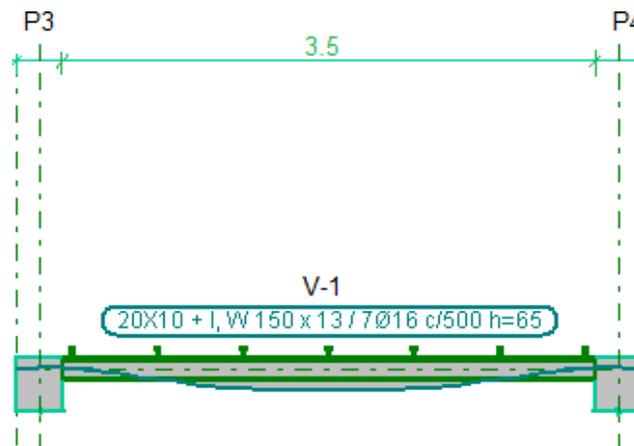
Detalhamento da viga mista da Opção 01 em corte longitudinal.
